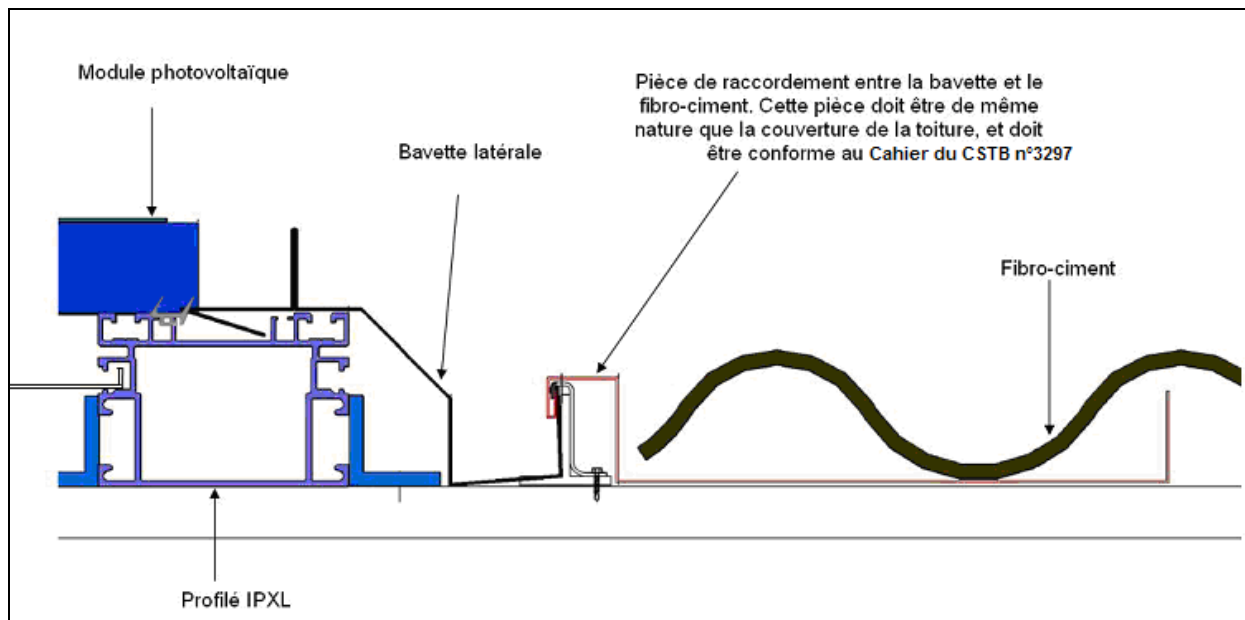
Illustration du raccordement latéral entre l'installation photovoltaïques et la toiture en plaques de fibres ciment
